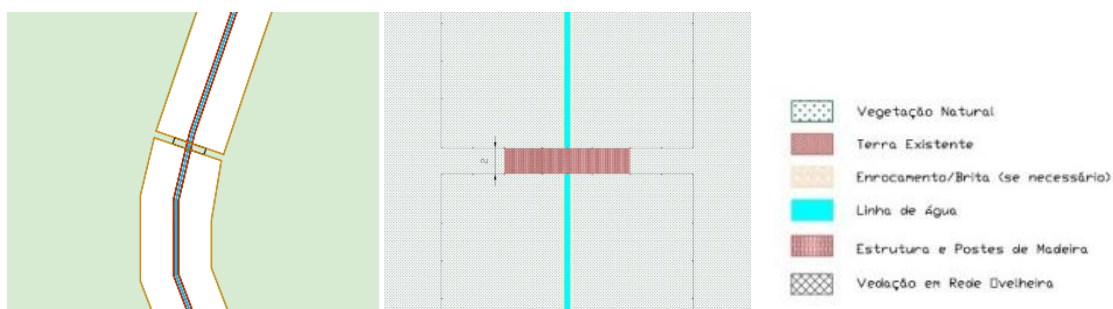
Planta de um atravessamento - Fonte: Volume I.RS, pág. 18 e extrato do Anexo C.Planta Síntese da Exploração
